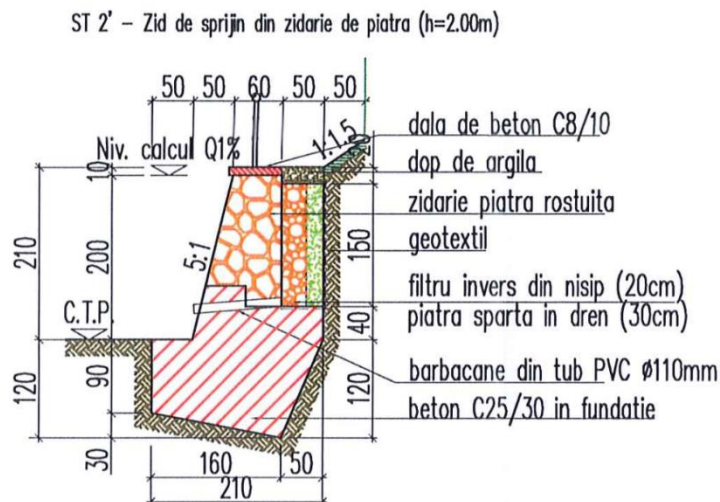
Secțiune caracteristică ST2' Zid de sprijin H=2.00 m prevăzut cu parapet metalic de protecție
